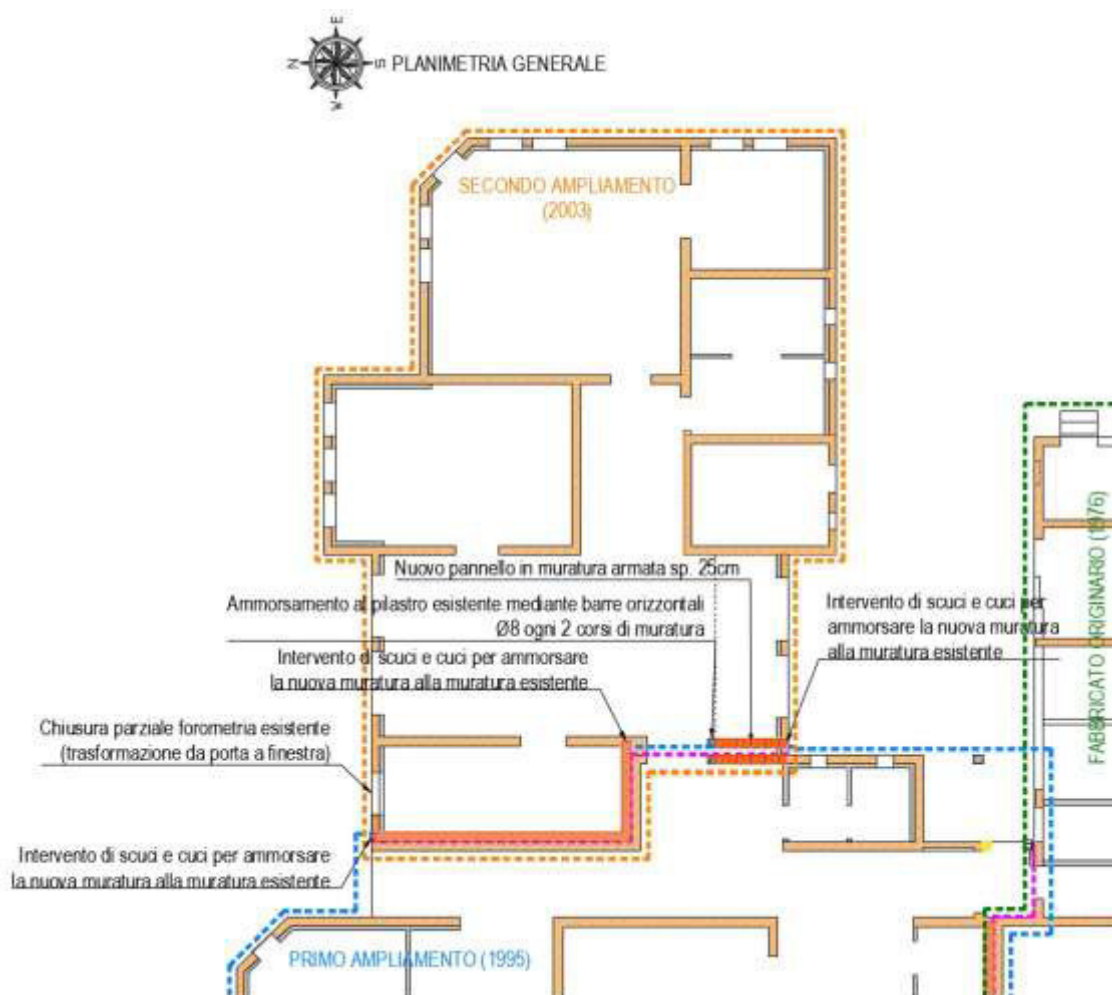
Pianta secondo ampliamento con descrizione interventi previsti in progetto
